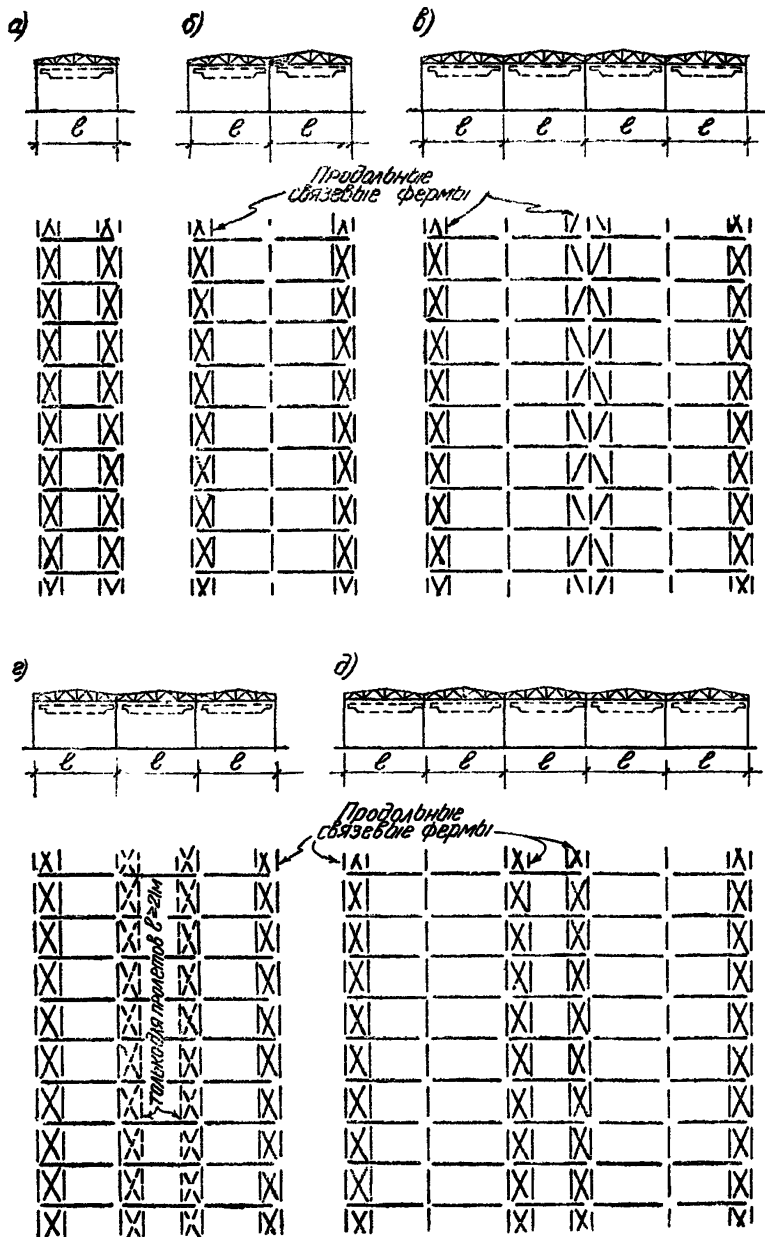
Схемы разбивки продольных связей по нижним поясам ферм
